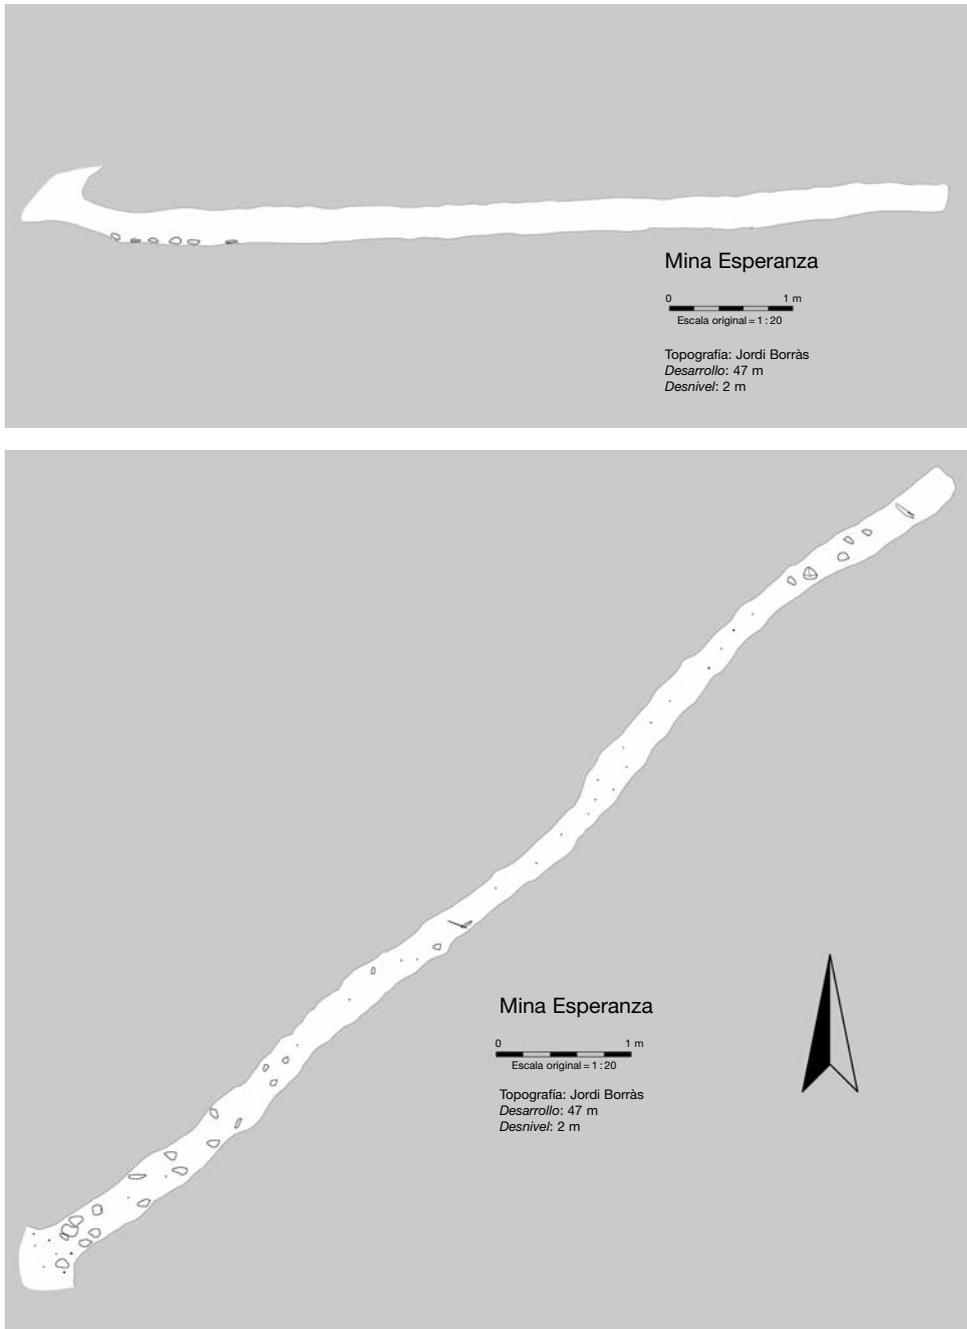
Perfil y planta de socavón minero en Labaza (valle de Bujaruelo).
